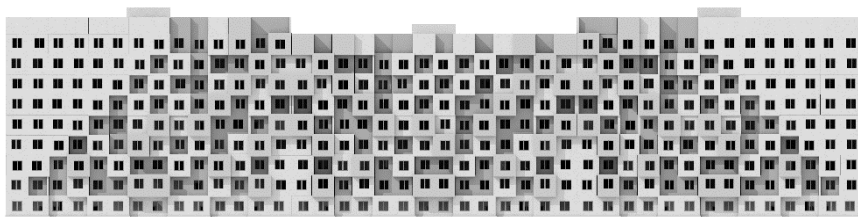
Решение фасада крупнопанельного многоэтажного дома с продольными несущими стенами с квартирами в двух уровнях
